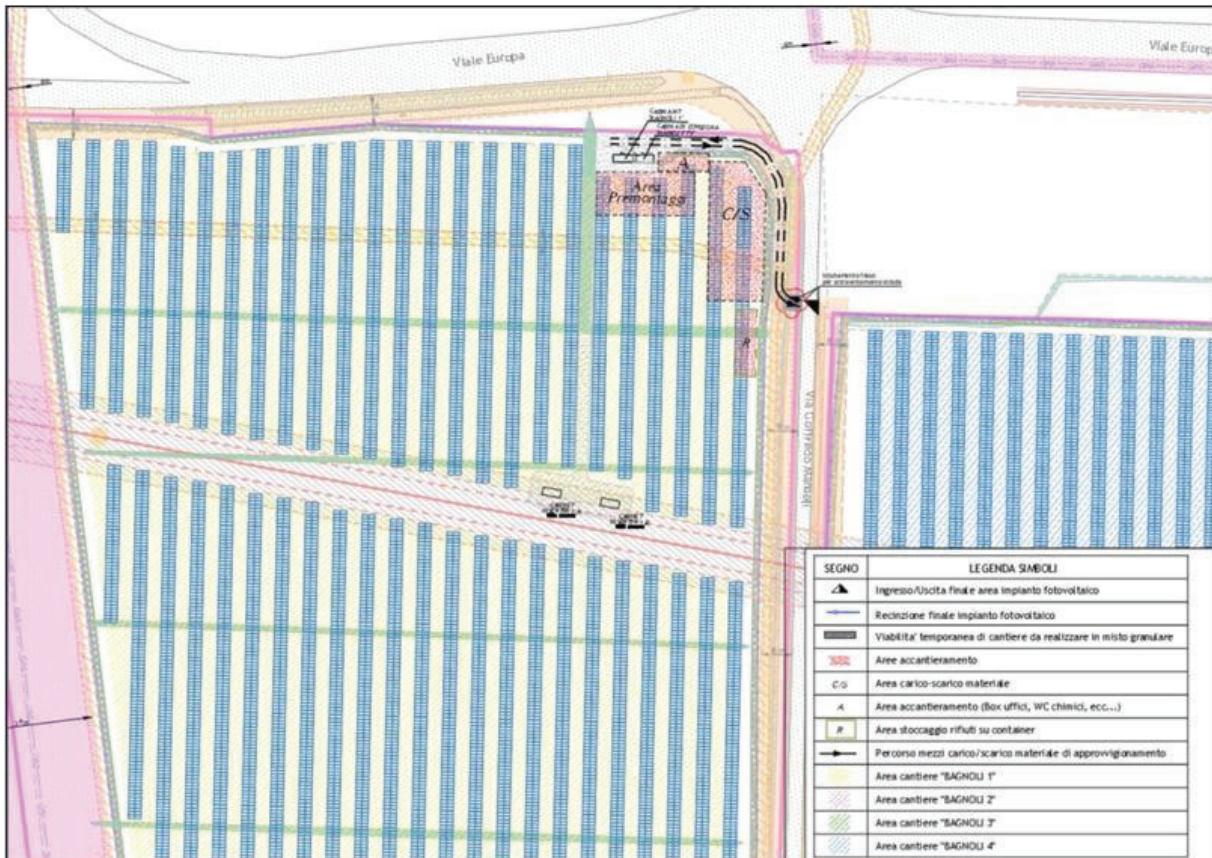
Aree di cantiere impianto BAGNOLI 1
